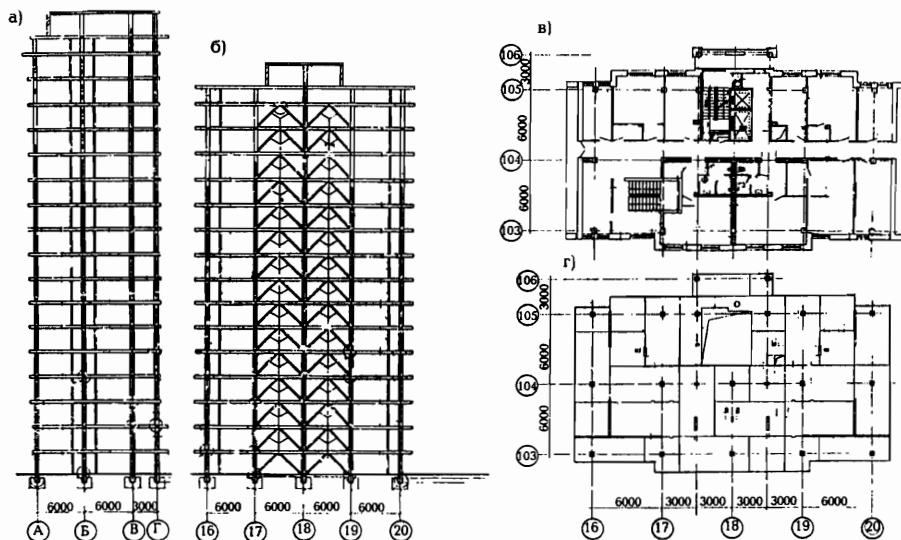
Разрезы и планы секций многоэтажного 5-ти секционного жилого дома: а – поперечный разрез 16-этажной секции; б – продольный разрез 14-этажной секции; в – план типового этажа; г – схема расположения колонн и плит перекрытия
